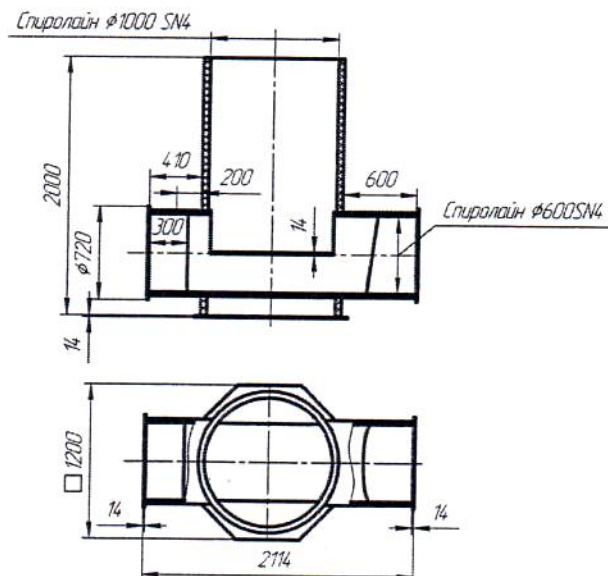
Конструкция колодца сварного для испытаний
